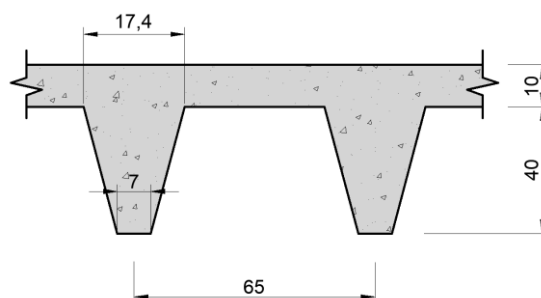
Projeto C1 - Seção da laje nervurada (dimensões em cm).
